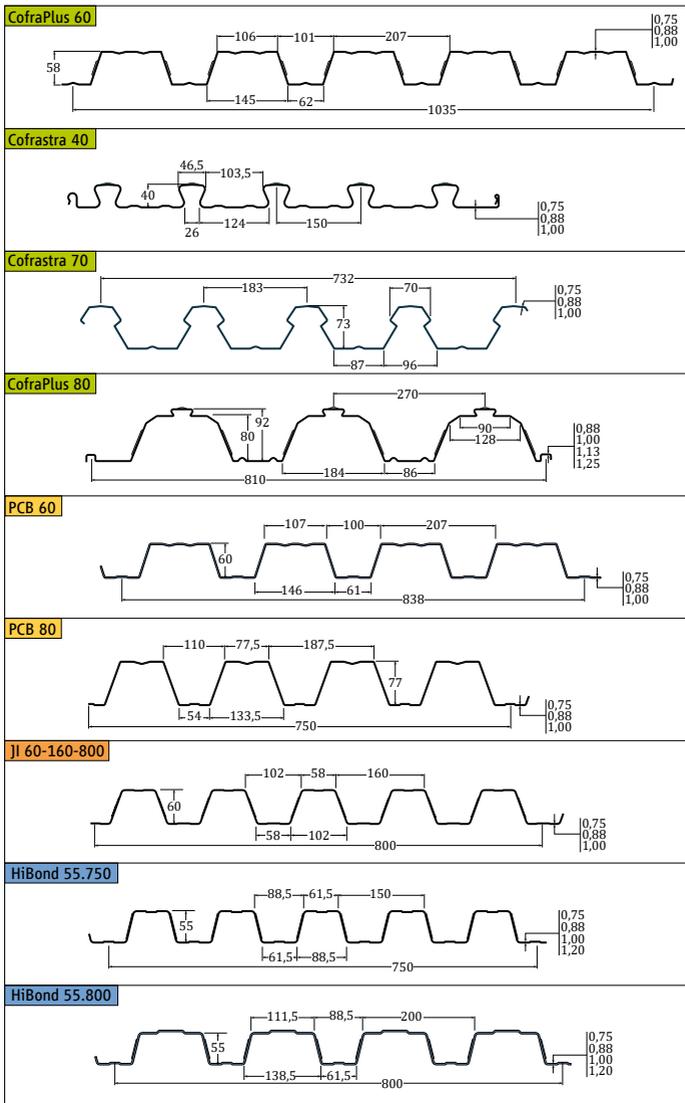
Bacs collaborants couramment utilisés pour des dalles mixtes sur le marché français
